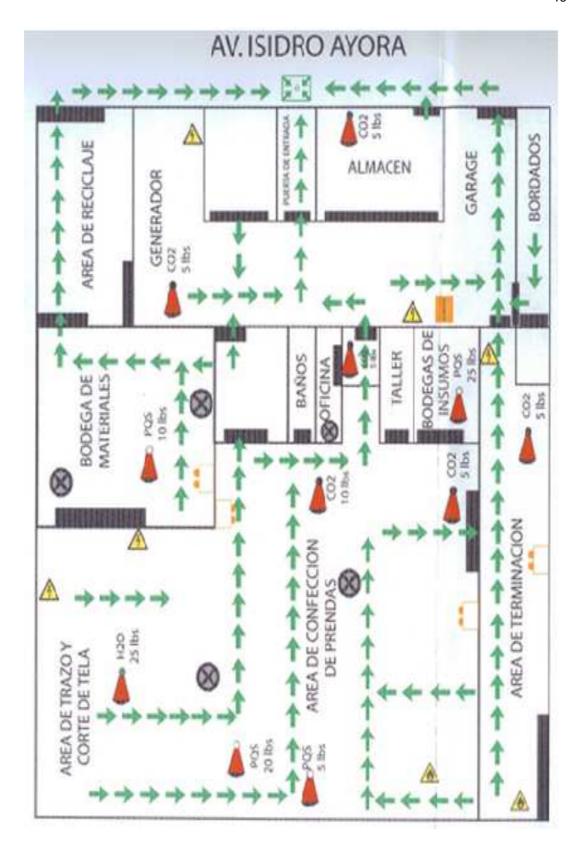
Layout Planta Baja (Fabicon, 2010)
